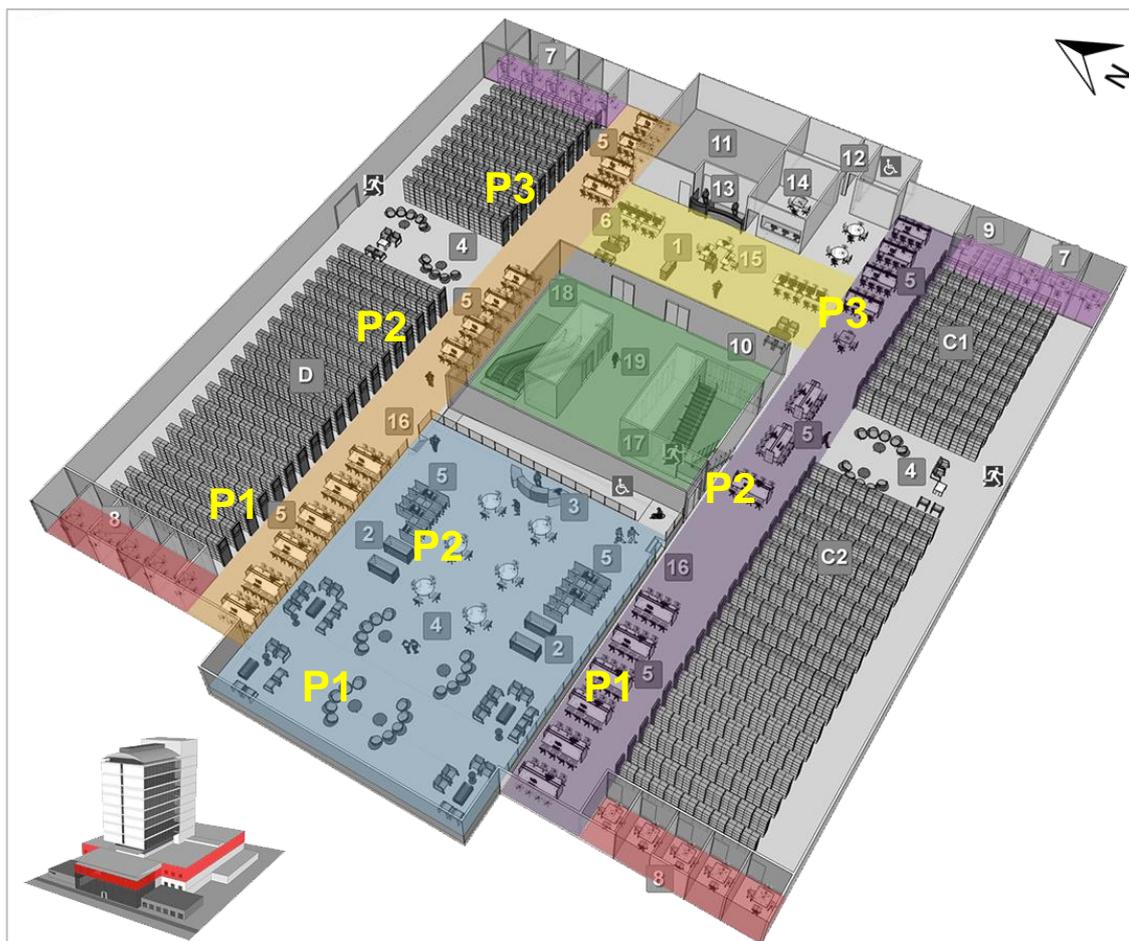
Perspectiva planta baixa 2º pavimento
